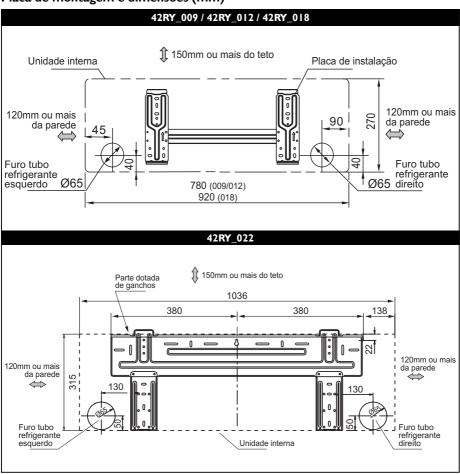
PLACAS DE INSTALAÇÃO / MONTAGEM
